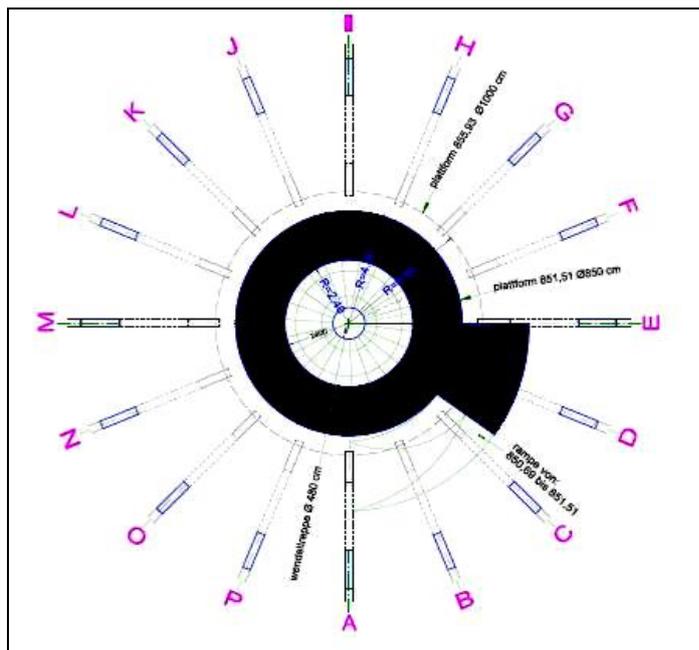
Schnitt und Grundriss der Architektenplanung
